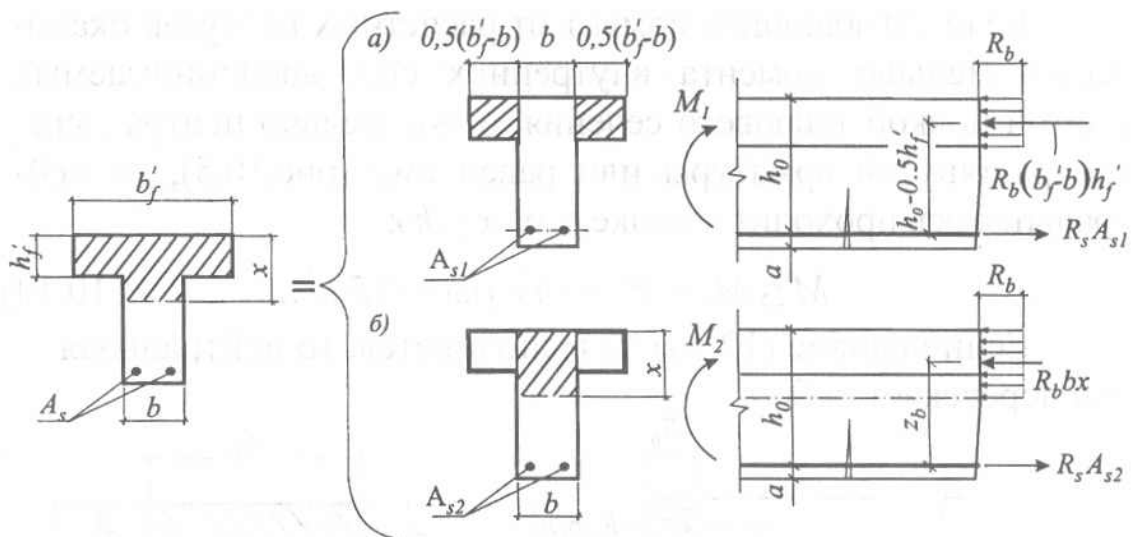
К расчету таврового сечения с полкой в сжатой зоне:
